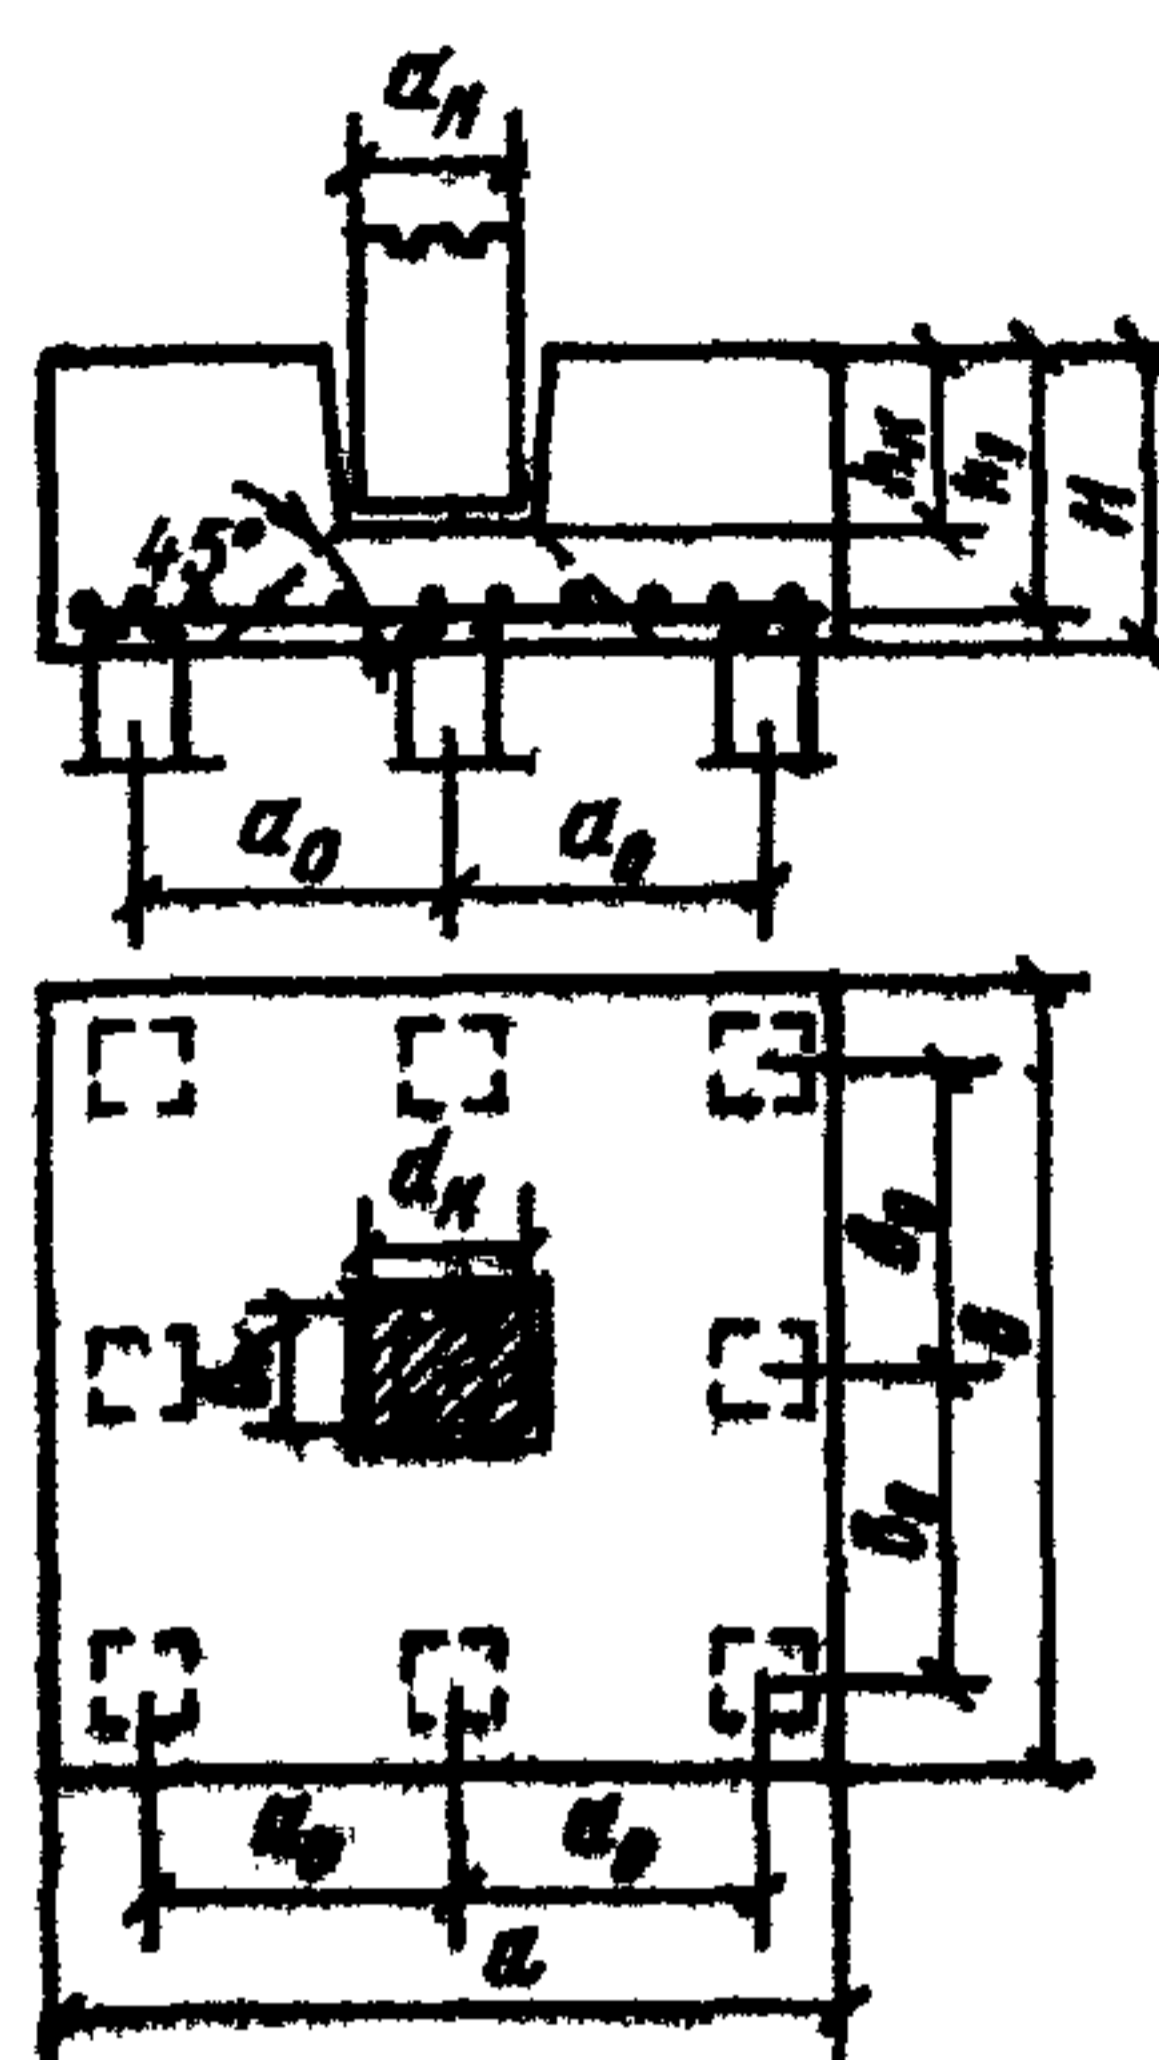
Схема расчета нижней плиты ростверка на продавливание угловой свай
